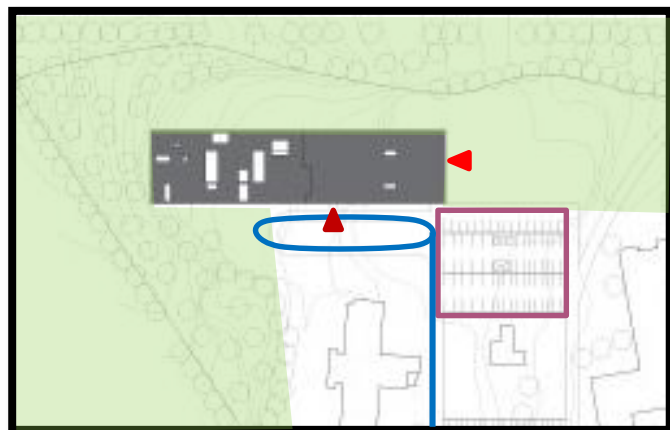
analyse du plan de masse du centre du Pays-Bas
